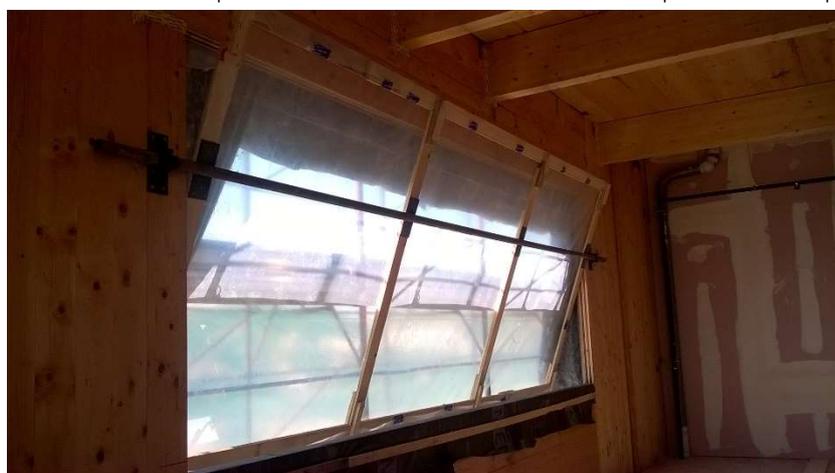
Infissi provvisori realizzati per proteggere le strutture durante il cantiere.
